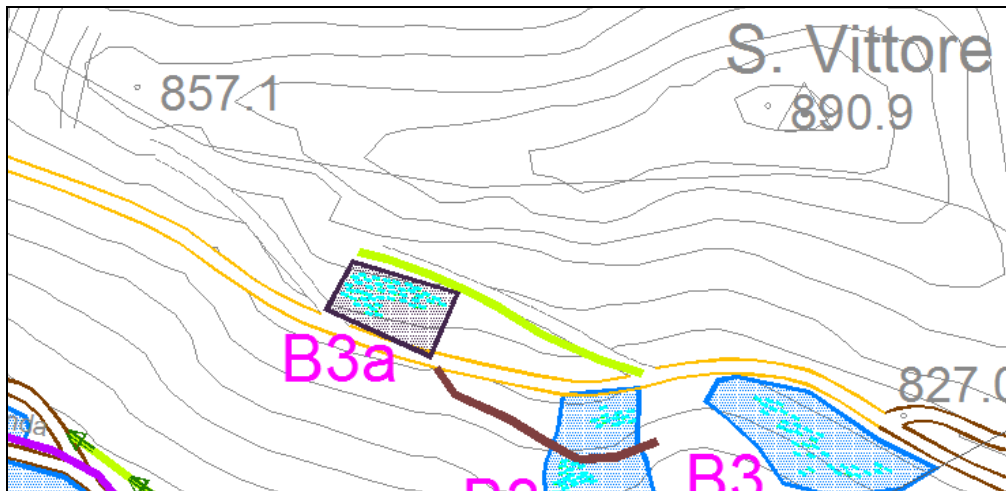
Unità progettuale B3a (cfr. elaborato C2 - Planimetria generale di progetto)
